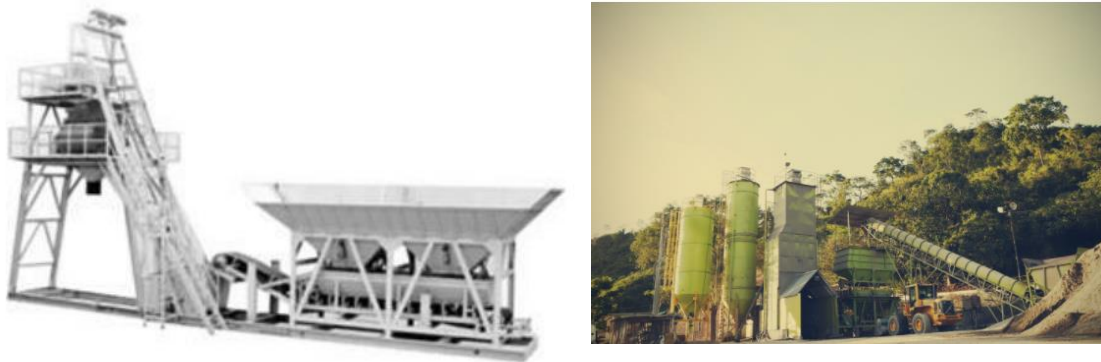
Planta Pre-mezcladora de Concreto FUENTE: Doplin clasificados
